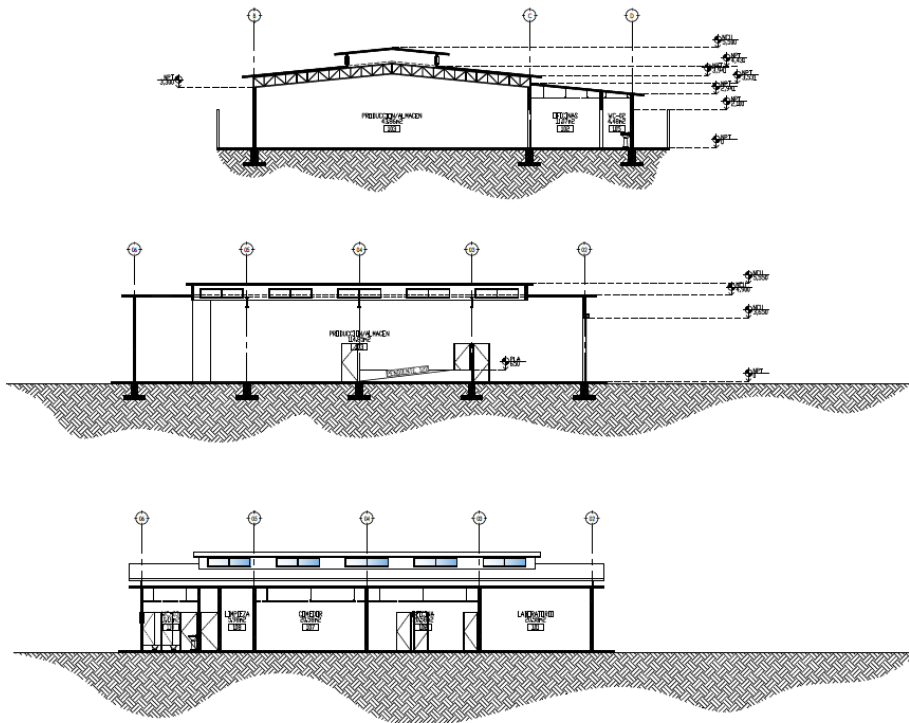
Plano Cortes de Anteproyecto. *Elaboración Propia TDU. Ver Anexo 15.
